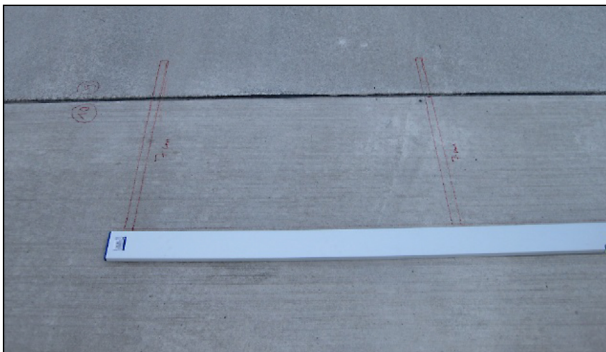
Anzeichnen der Schlitzmaße auf der Waschbetonstrecke 40
